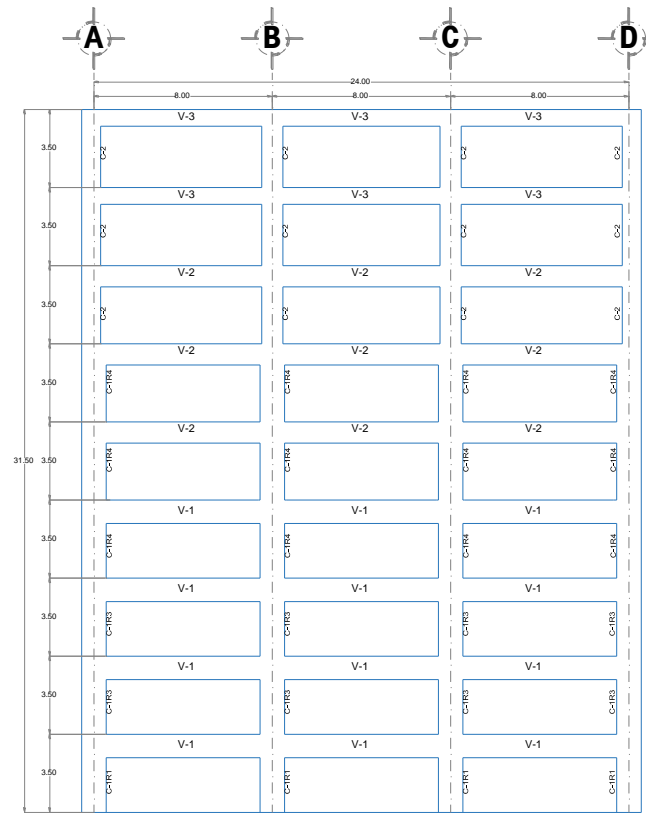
Alzado de armado de columnas y vigas de edificio de 9 niveles con base a la hipótesis de las NTCC-04.
